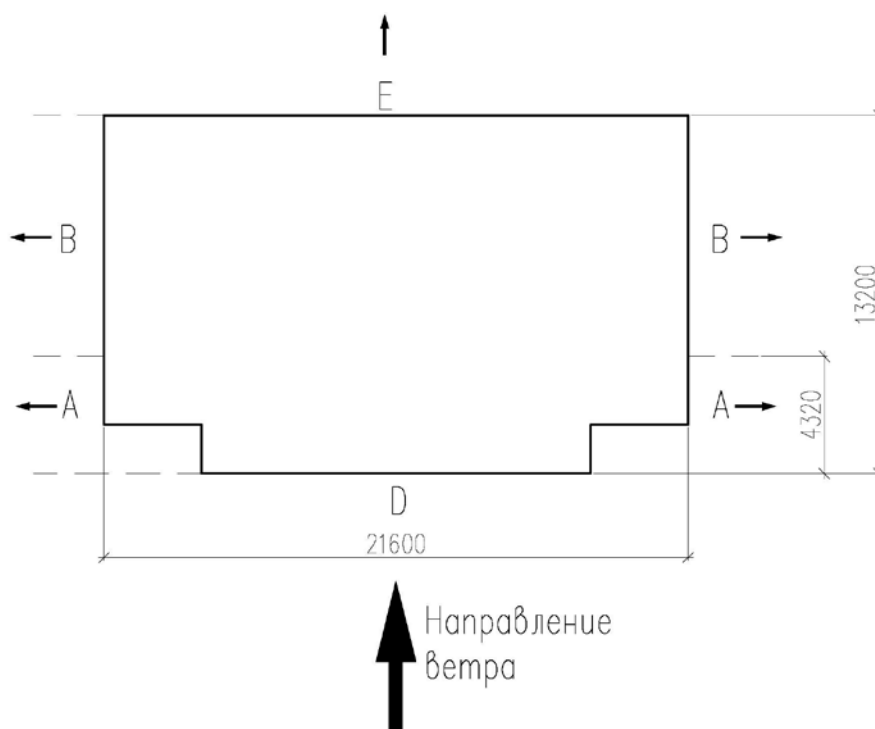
Схема ветровой нагрузки на здание (вид в плане) при ветре спереди
